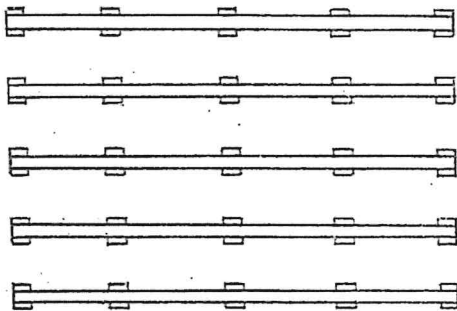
Lager (Kanthölzer auf Betonsteinen (Draufsicht))
